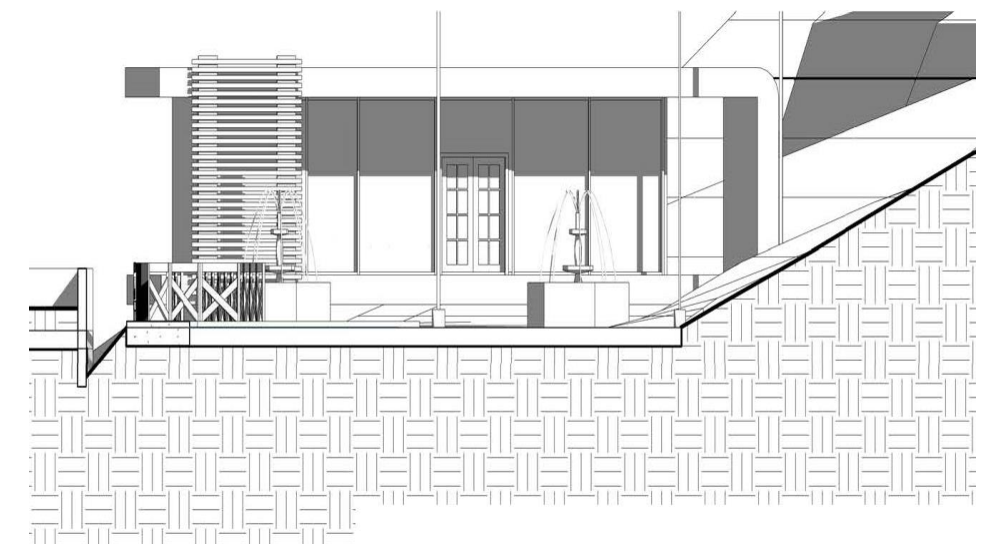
Corte de terreno, Administración. Monte Carmelo
